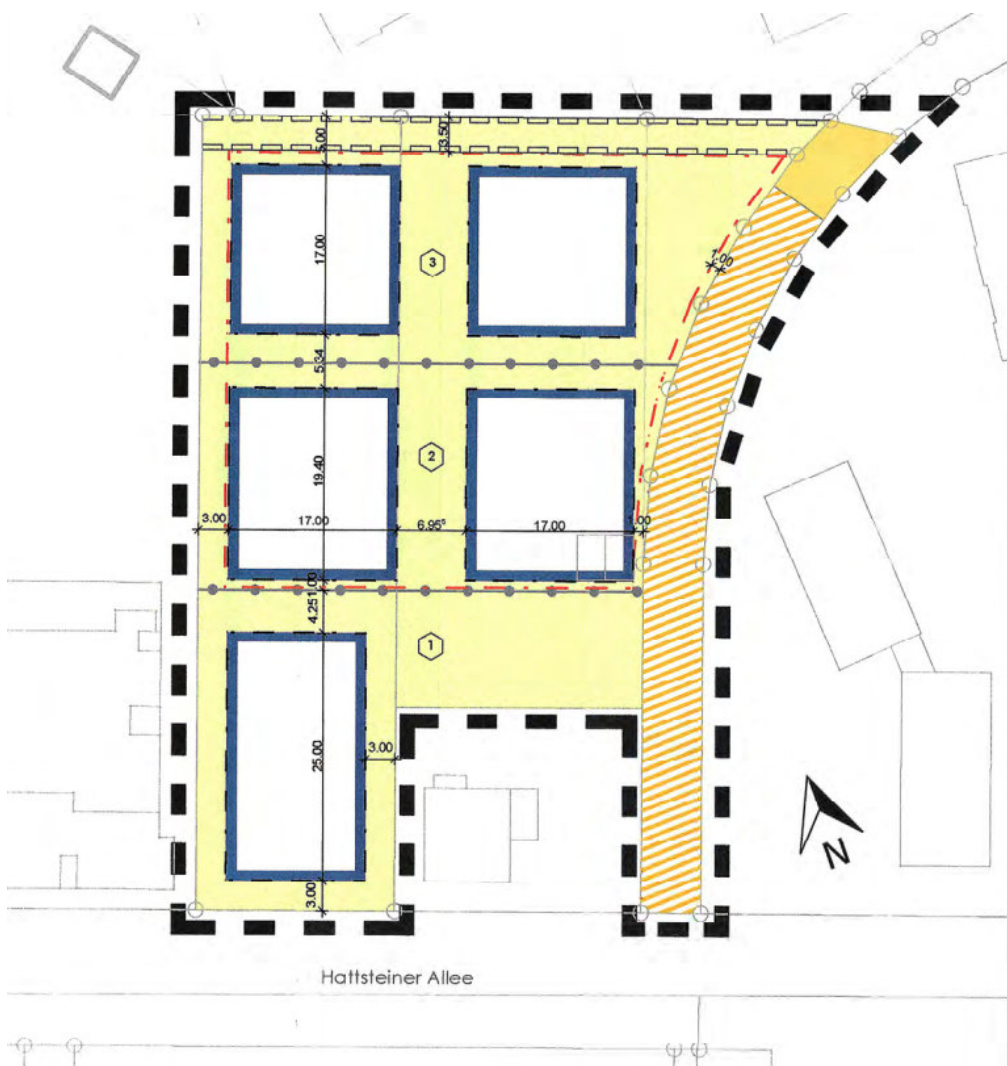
Bebauungsplan „Hattsteiner Allee 20 – 22“, nur Planzeichnung
